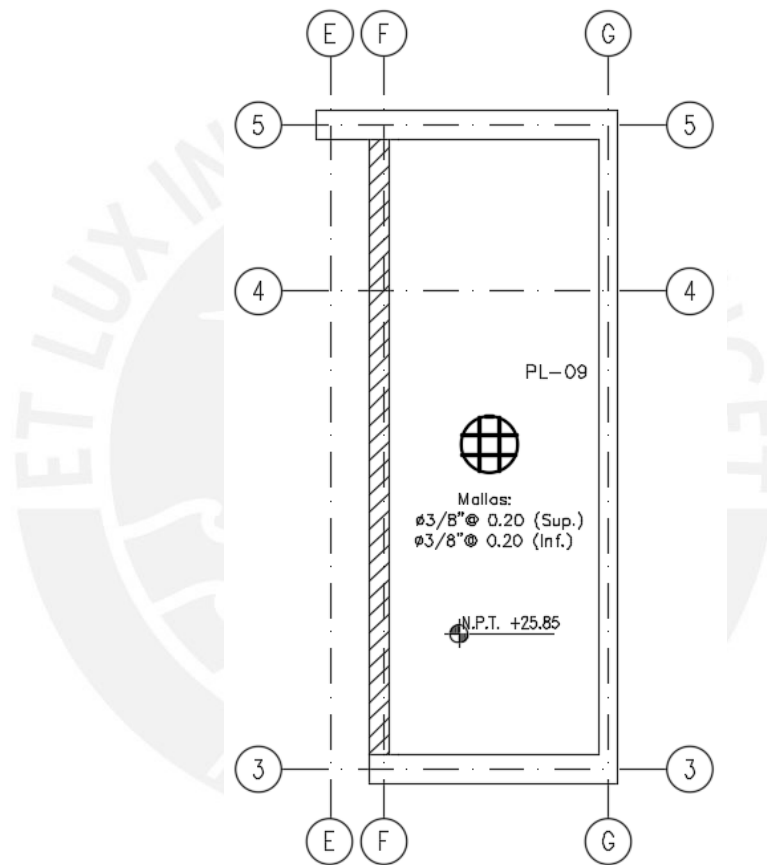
Disposición final de acero en la losa de piso del tanque elevado.
